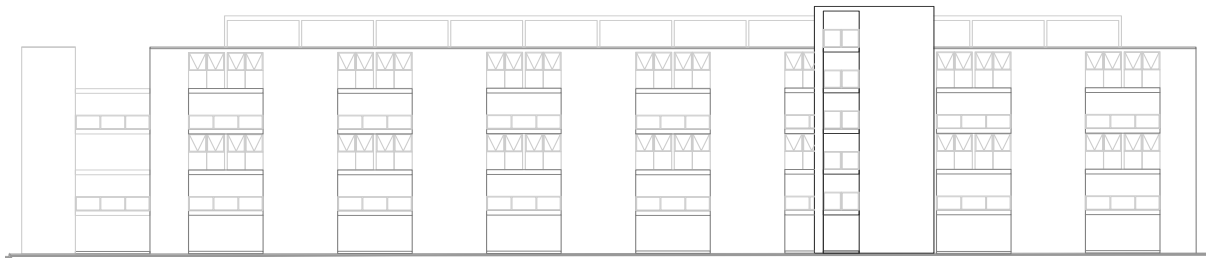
Fachada este de edificio tipo A, Fuente: Luz Pirr'on y elaboración propia
